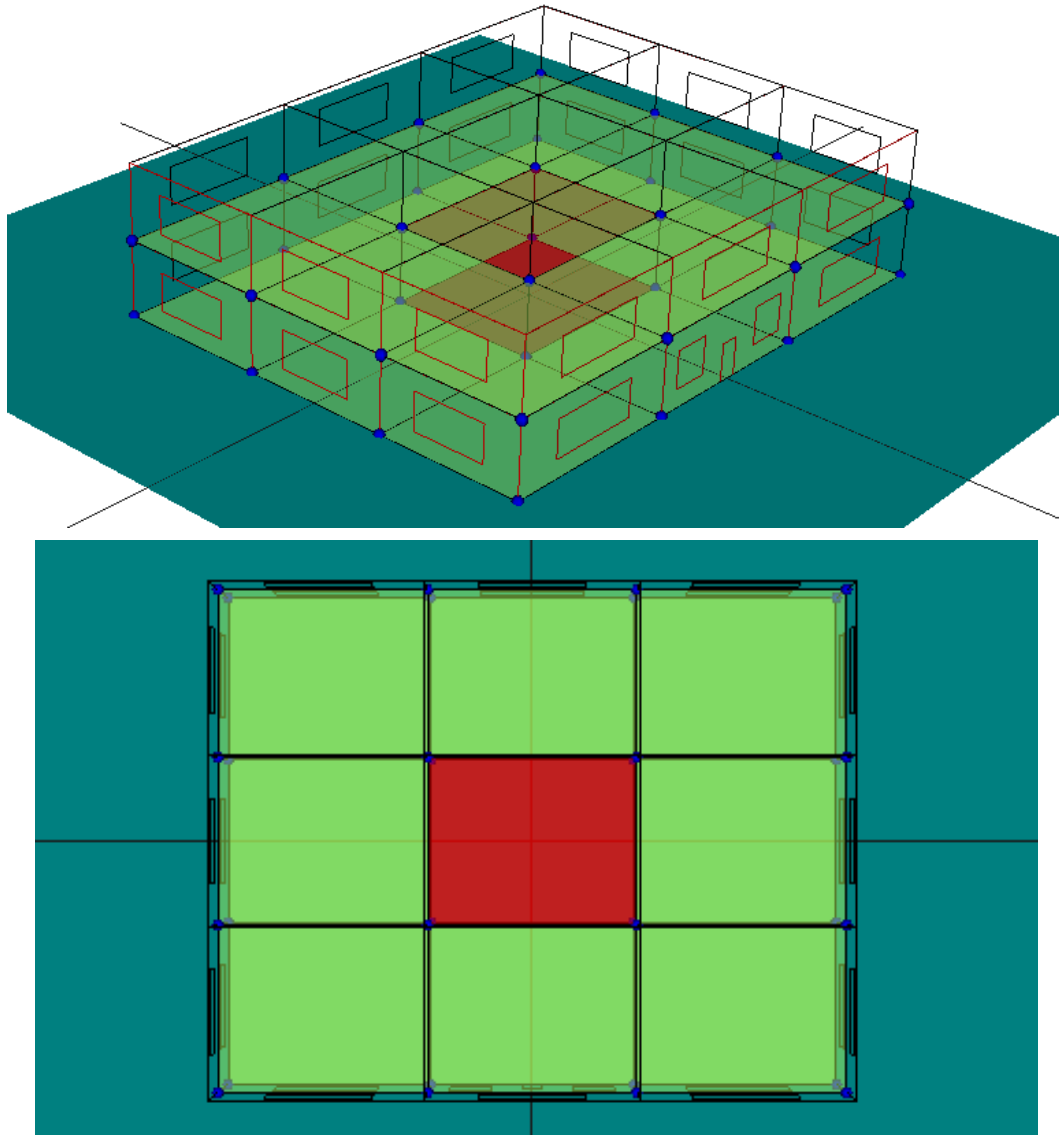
Vista de los espacios donde se sitúan las unidades terminales de calefacción, para la vista tridimensional (arriba) y en planta (abajo) del caso A (edificio simplificado).
